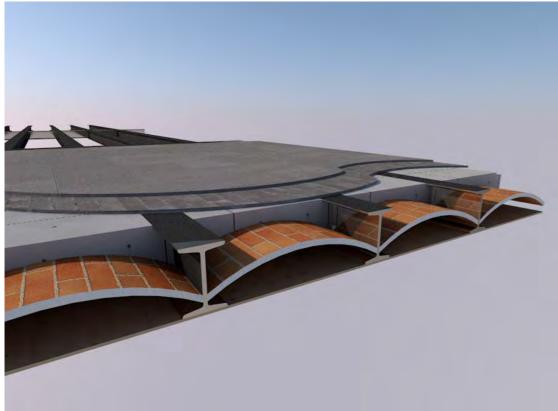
Perspectiva renderizada de un forjado de revoltón con viguetas metalicas
